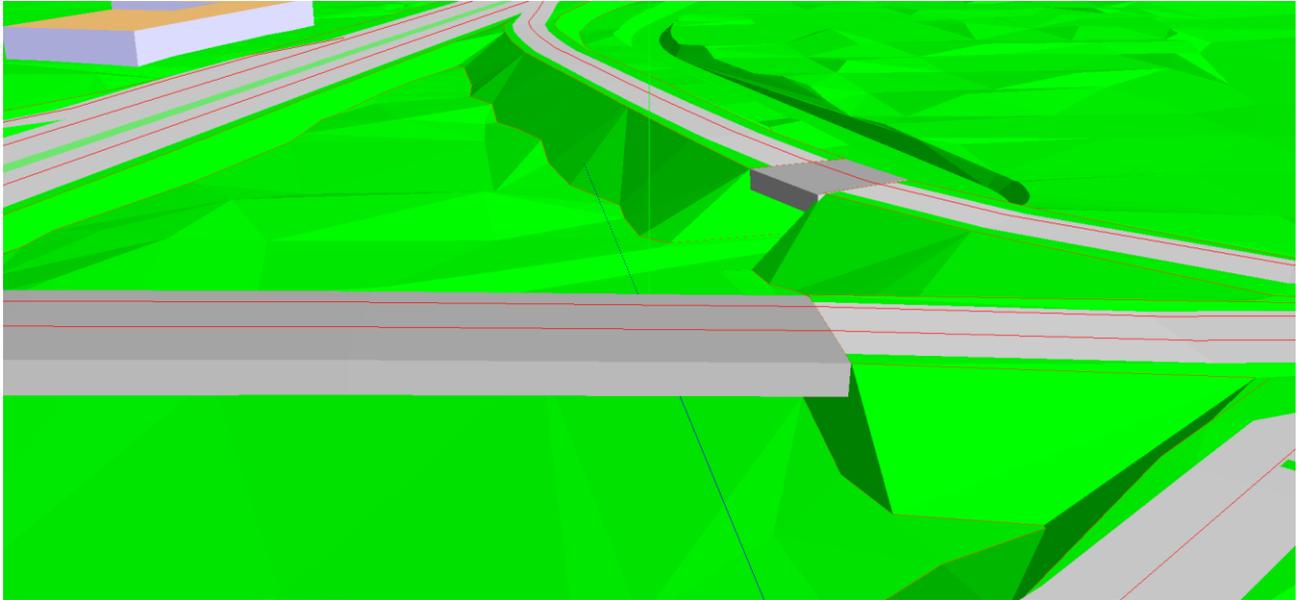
Dettaglio della modellazione in SoundPlan di due dei rilevati previsti dal progetto
